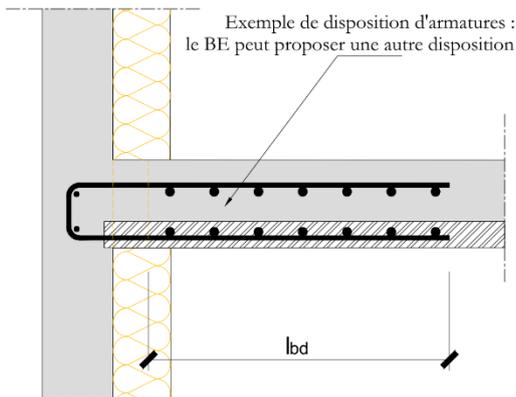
Détail de la bride – Cas des dalles coulées sur place sans balcon
